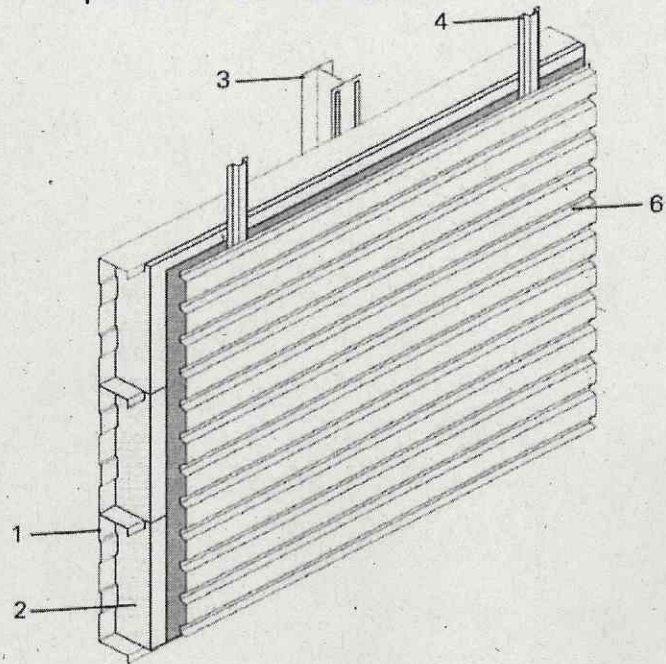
Schema des Baus einer Wand- Wände mit Fassade aus Fassadenpaneelen
